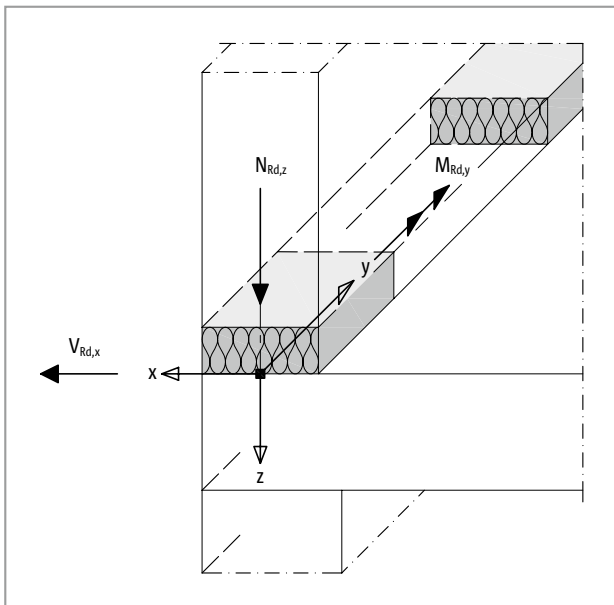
Schöck Isokorb® T tipo A: Signos convencionales para el cálculo
